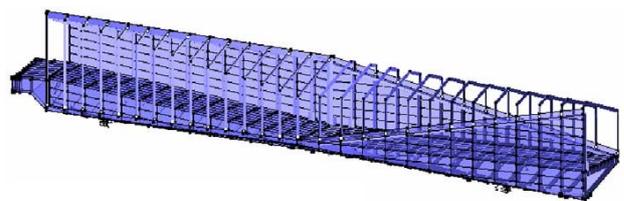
Paradise Street Pedestrian Bridge 構造図⁸⁾
